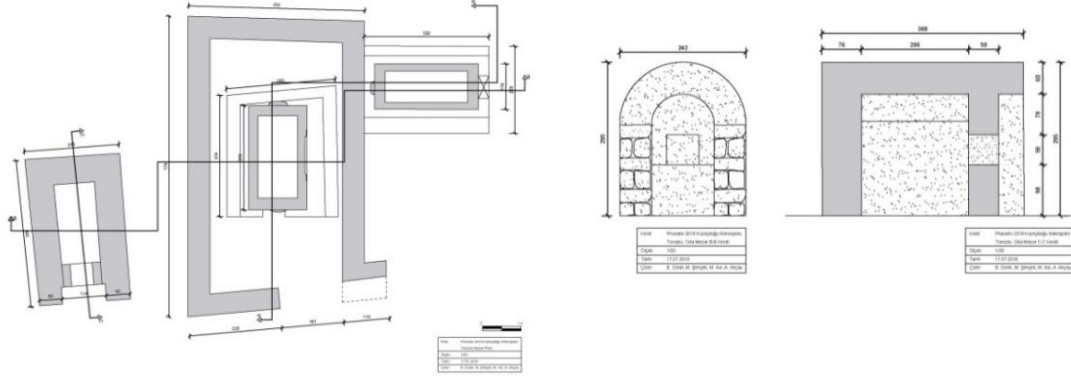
Semerdamlı Lahit ve Mezar Odası Plan ve Kesit
